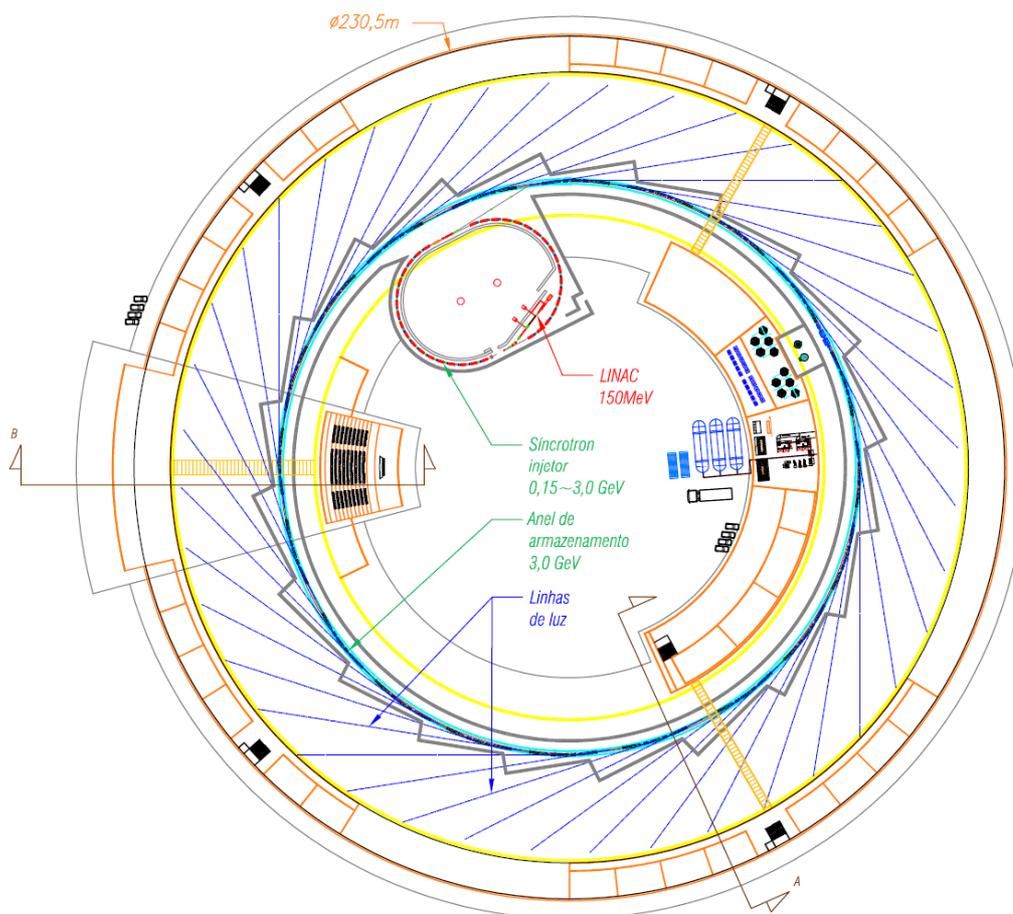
Planta baixa do projeto arquitetônico básico do Projeto SIRIUS
